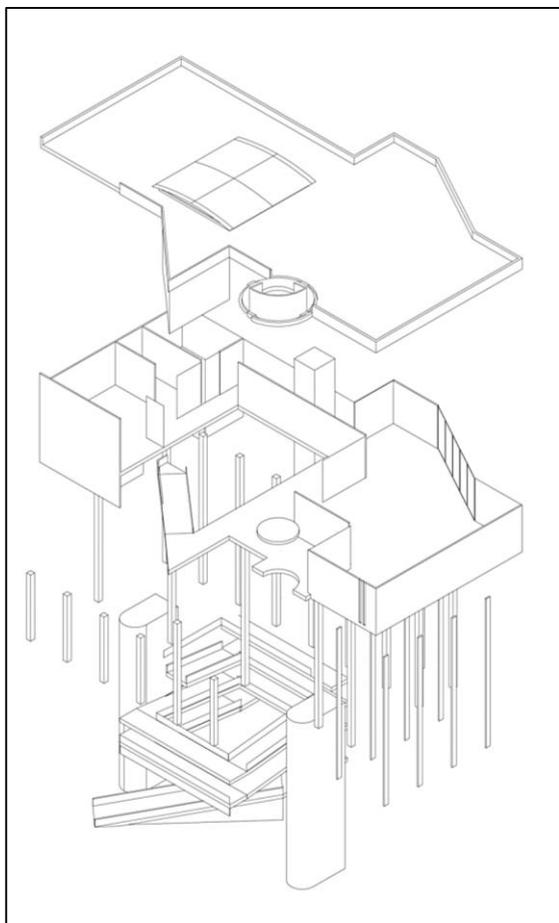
Sistem struktur rangka konstruksi beton.
